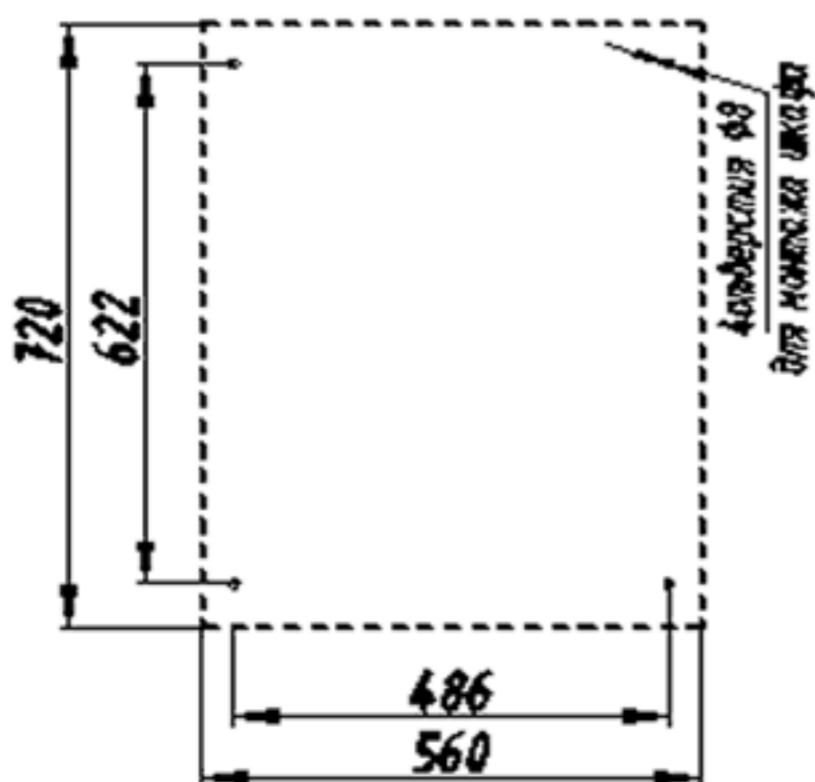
Схема разметки отверстий для монтажа корпуса ШУ-2 (навесного).
